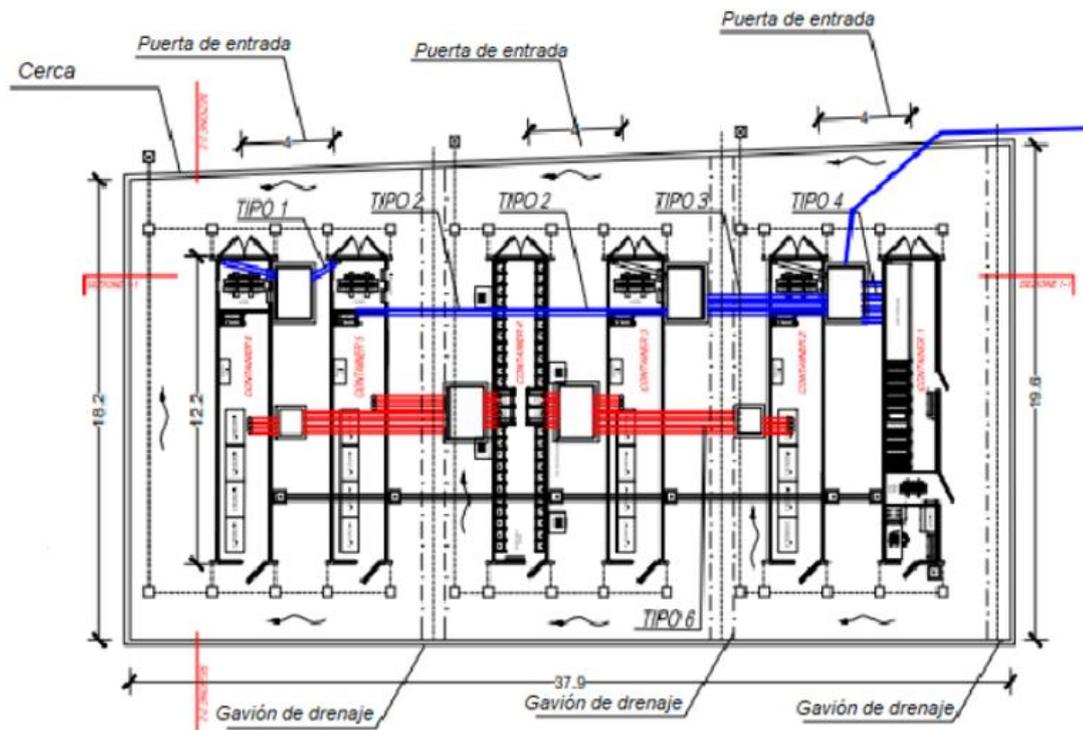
Disposición de los prefabricados. (Ficha técnica fabricante).
